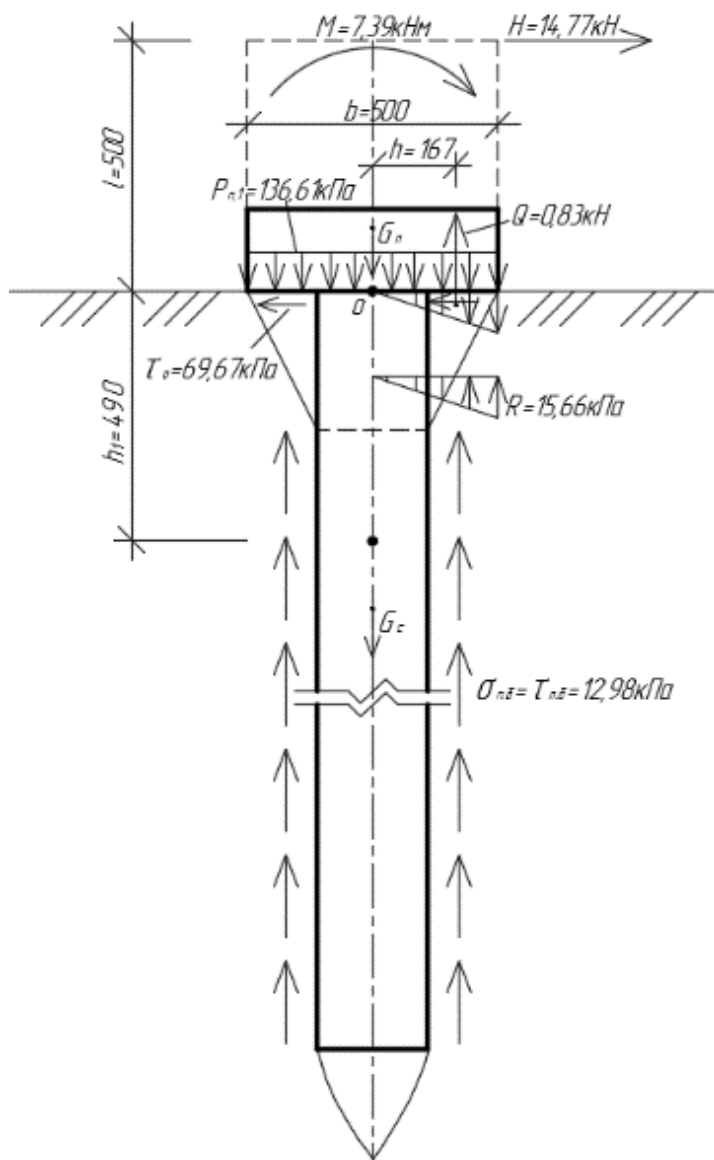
Схема односвайно-плитного фундамента с приложенными к нему горизонтальной нагрузкой и изгибающим моментом
